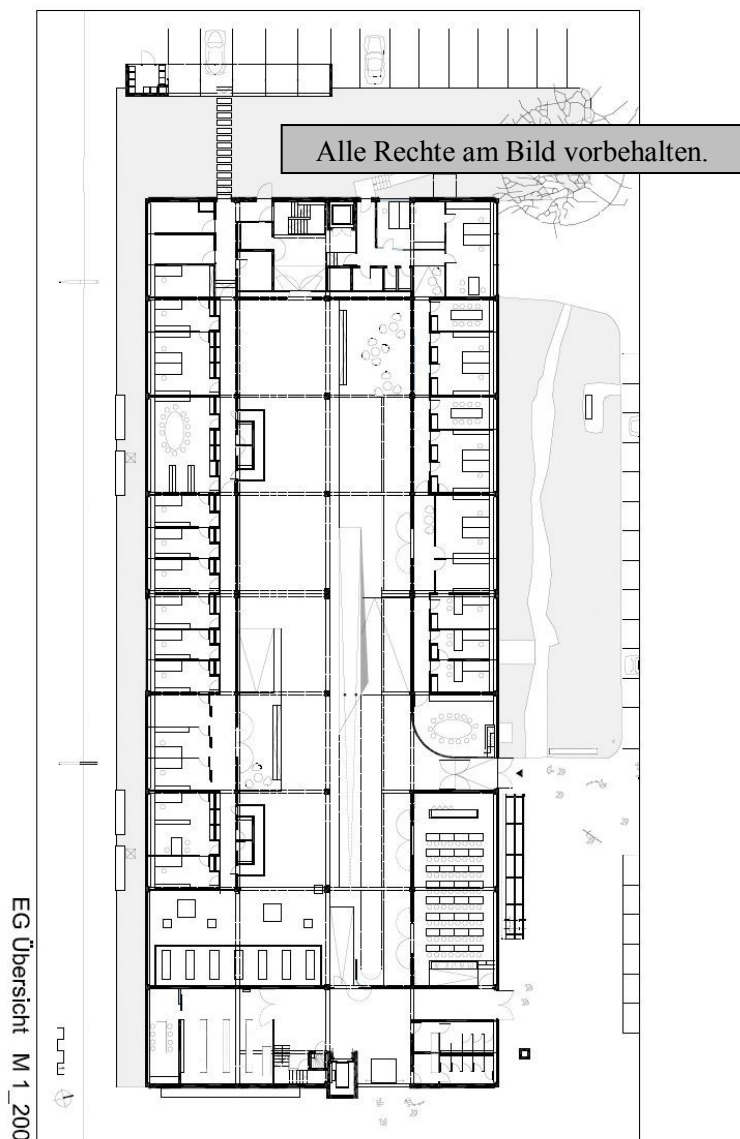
Pausa-Halle, Grundriss EG. © baldauf architekten gmbh.
